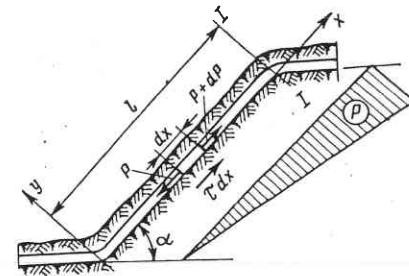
Схема к расчету усилий в трубопроводе на продольном участке
